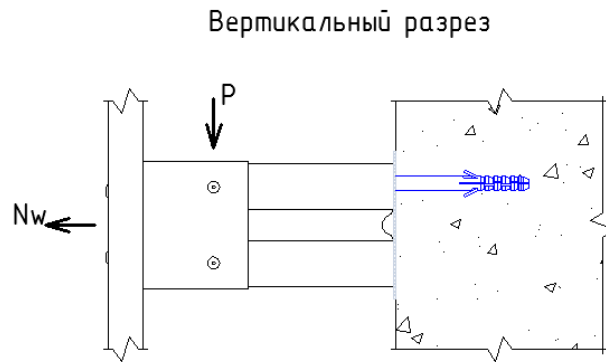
Конструктивная схема для проверки соединения удлинителя с кронштейном
